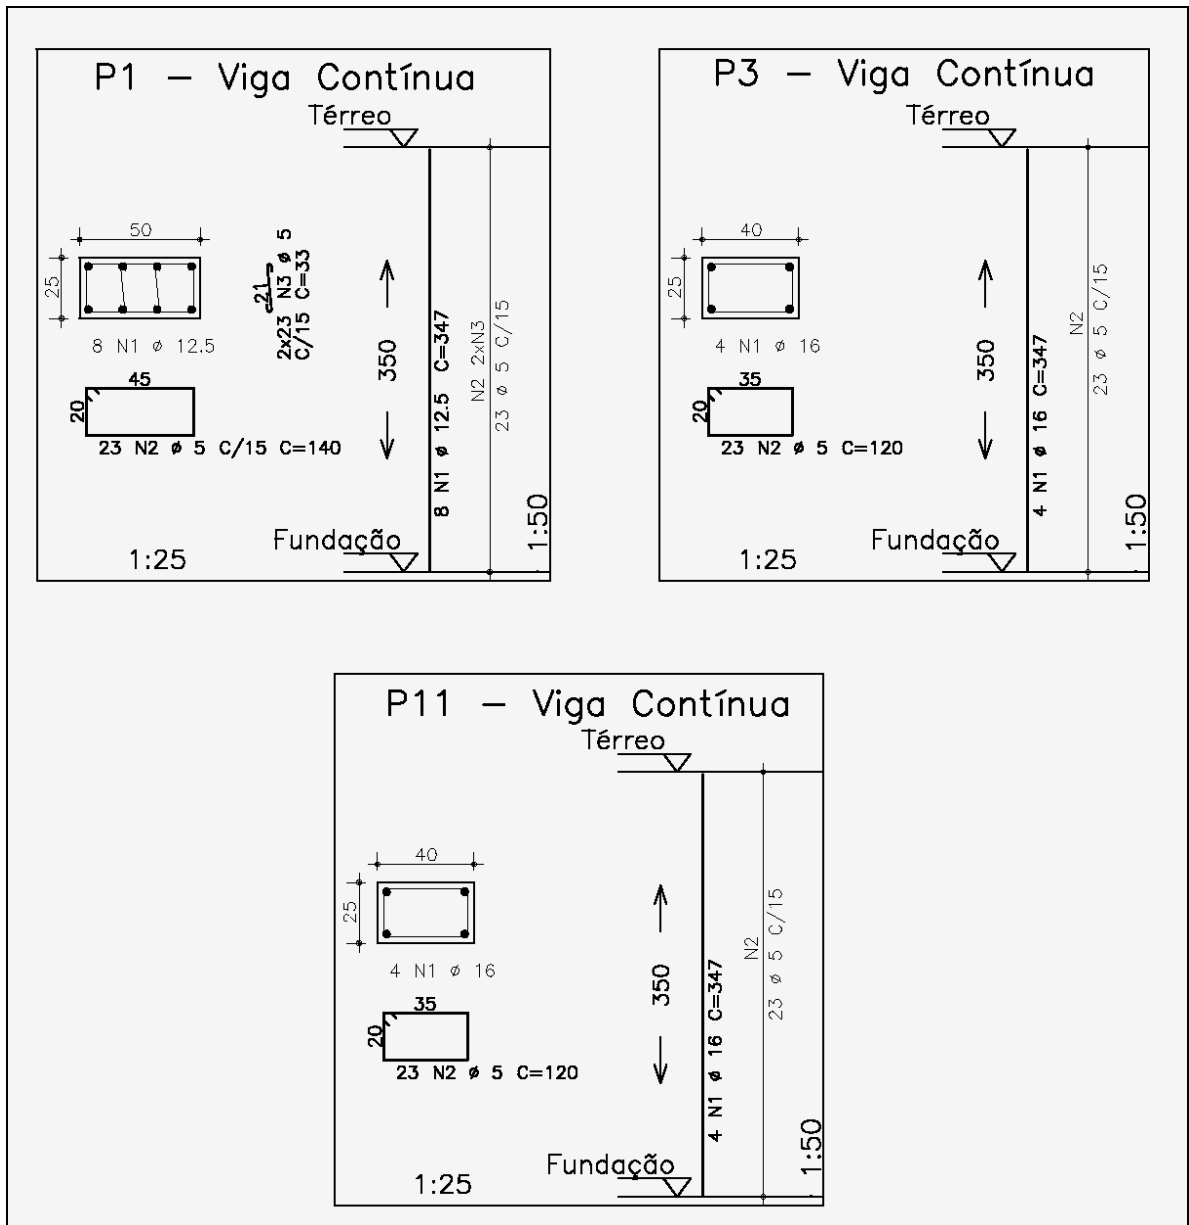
armaduras dos pilares pelo modelo de viga contínua
